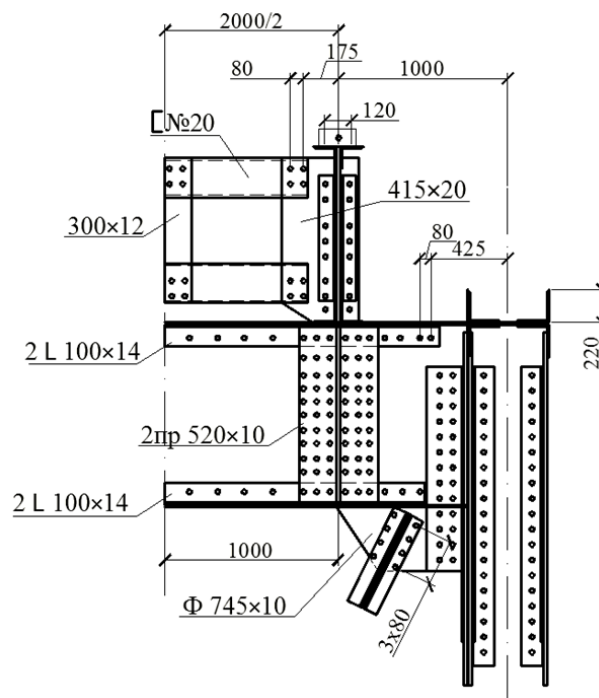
Конструкція балочної клітки в прогонових будовах ПСК з іздою верхом
